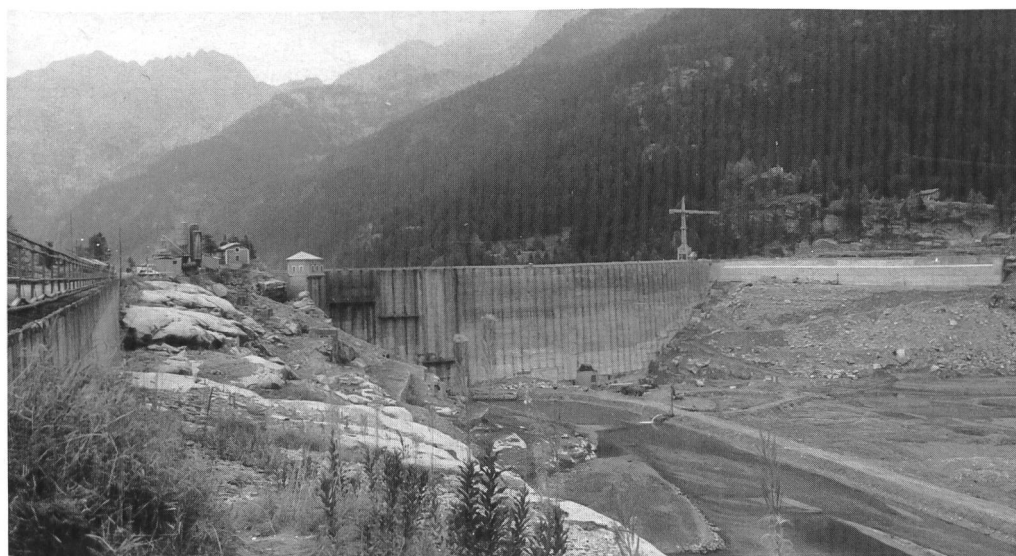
Betonstaumauer mit Dichtungsgewölben aus Granitmauerwerk auf der Wasserseite nach dem Entleeren des Stausees.
